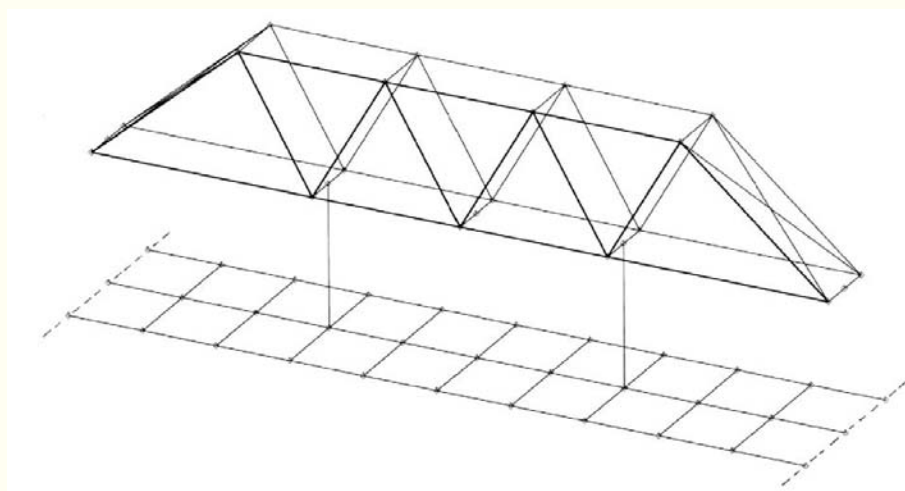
Systemausschnitt des Dachträgers mit angehängter Geschossdecke des Fitness-Studios
